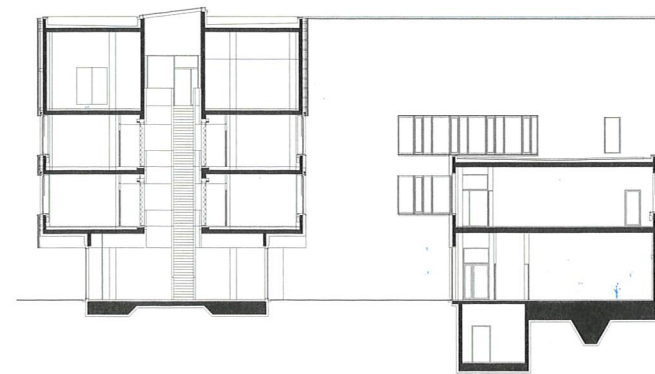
Querschnitt durch den viergeschossigen Bürobereich und den zweigeschossigen Laborbereich (Grafiken 5–7: Nickl & Partner Architekten)
